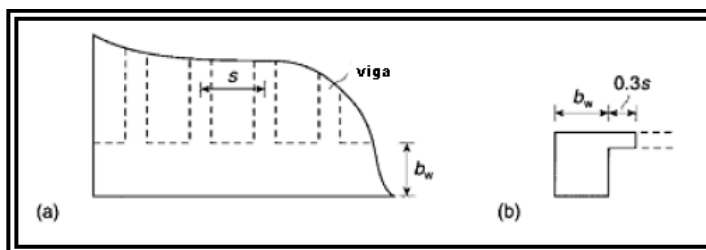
168 Ancho de ala efectiva para vigas diafragma: (a) Planta en el borde del tablero, (b) Sección de viga "L"¹⁸².
